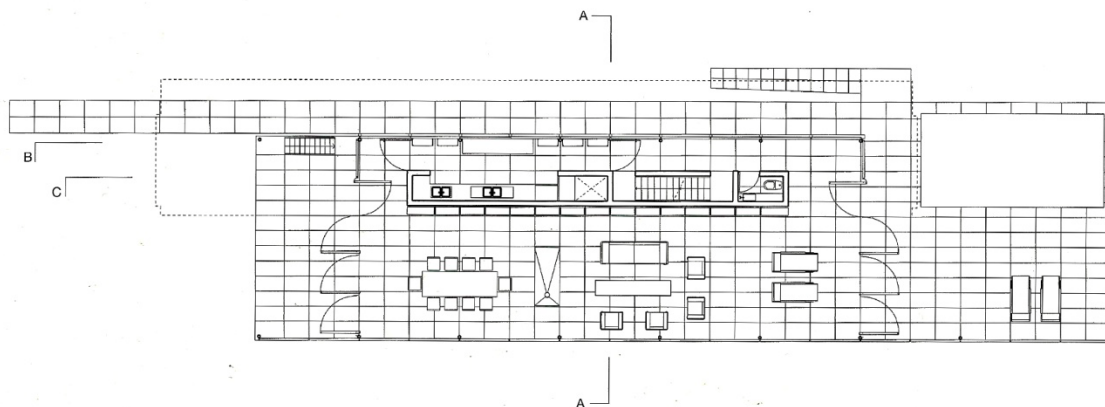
Planta primera. 2G Revista Internacional de Arquitectura
